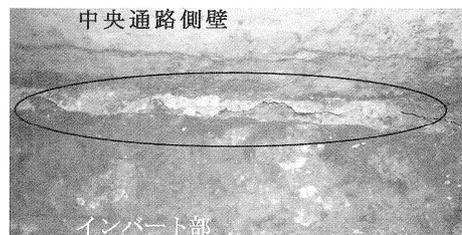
盤ぶくれによるインバート吹付けのひび割れ¹⁾
